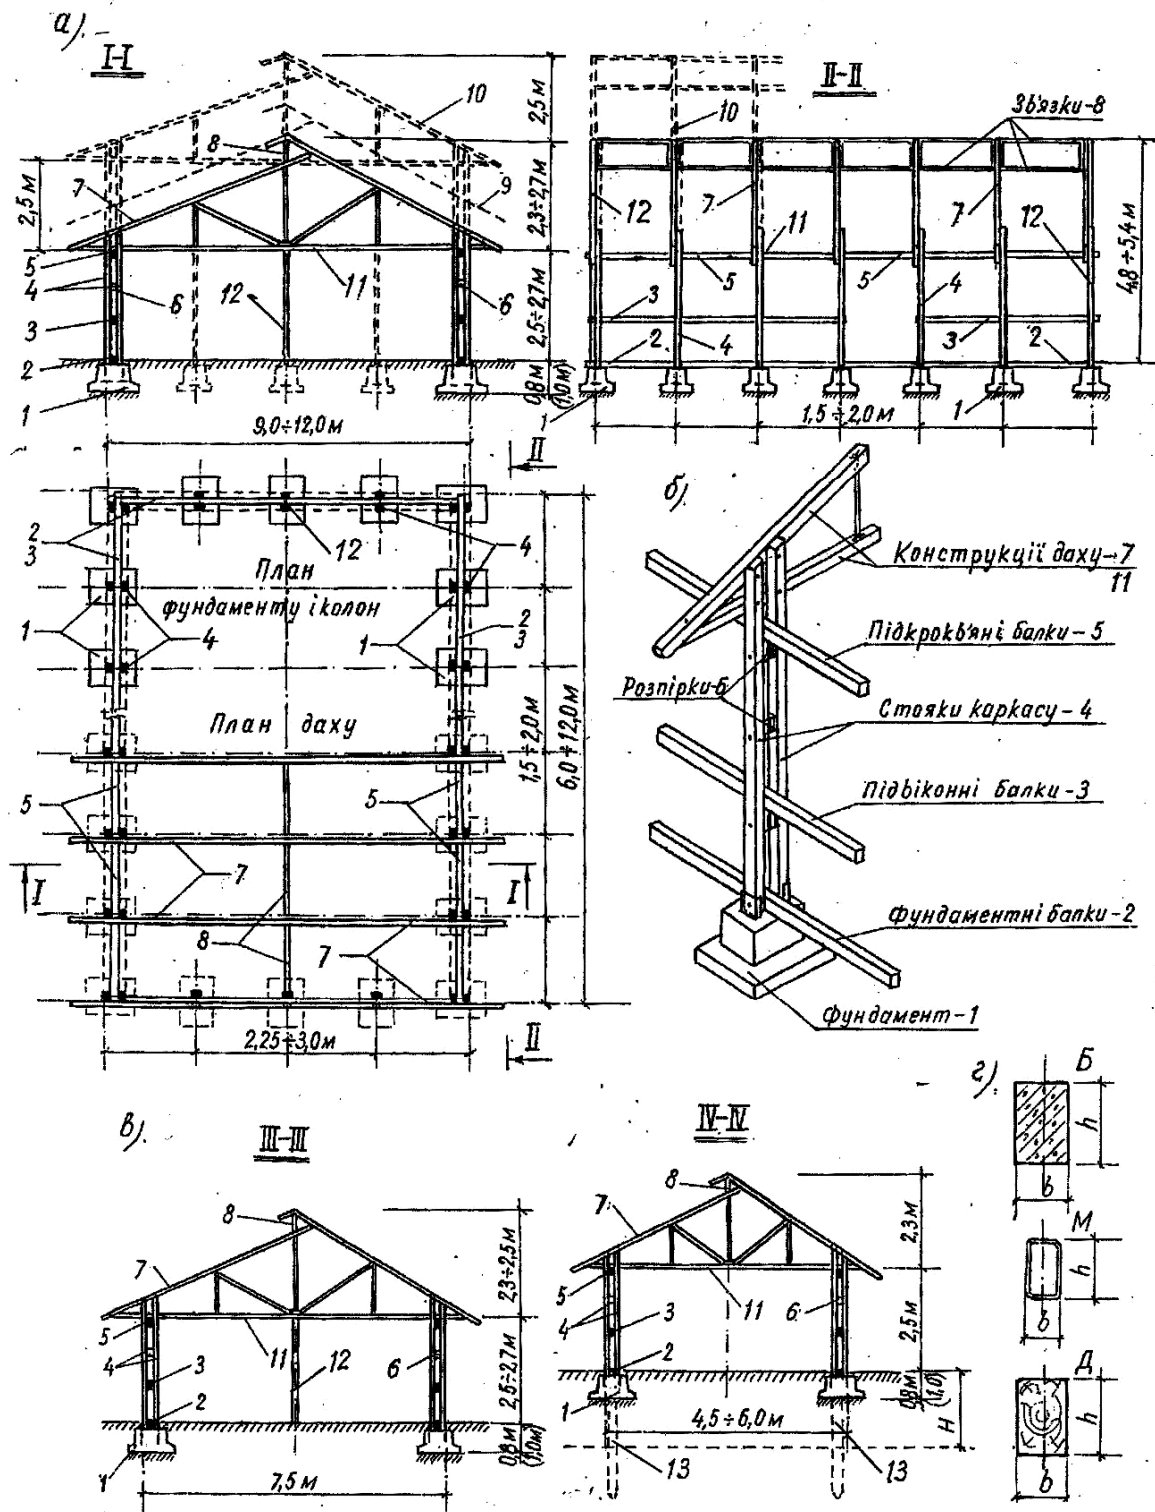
Схеми легкомонтованих збірно-розбірних каркасів для малоповерхового житлового та іншого будівництва: а – поперечний (I-I) і повздовжній (II-II) розрізи; план будинку; б – збірні елементи каркасів і дахів; 1 – фундамент; 2 – фундаментні балки; 3 – підвіконні балки; 4 – стояки колон; 5 – підкрівляні балки; 6 – розпірки двовіткових колон; 7 – конструкції даху і перекриття; 8 – зв'язки кроку; 9 – положення даху; 10 – положення даху в будинках з мансардами; 11 – балки перекриття; 12 – стояки середніх повздовжніх рам; 13 – палі фундаментів
